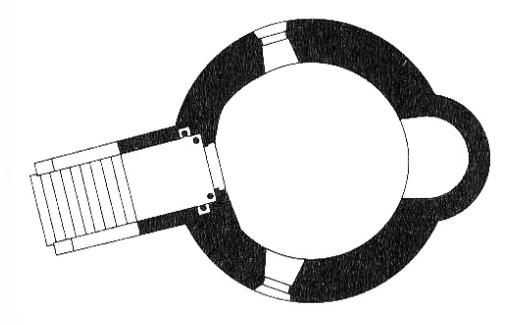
Grundriss Kühnring, M 1:200. Dehio NÖ 1990, 618.
